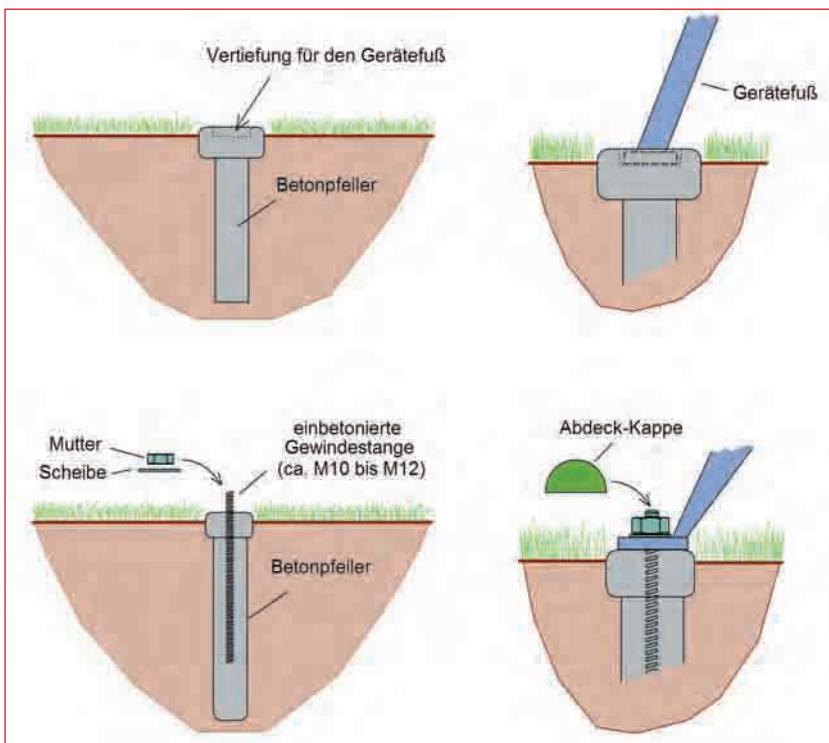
Einfache Betonfundamente (im Schnitt) z. B. für Kindersportgeräte
